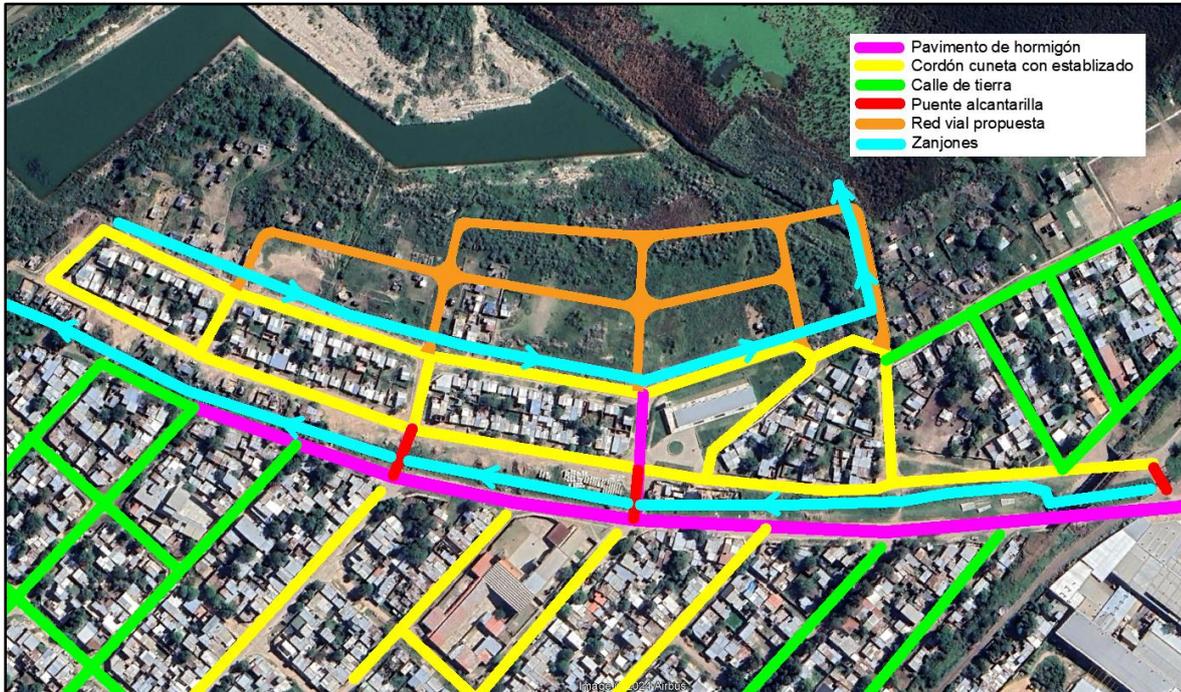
Tipos de pavimentos existentes en el barrio y traza propuesta.
